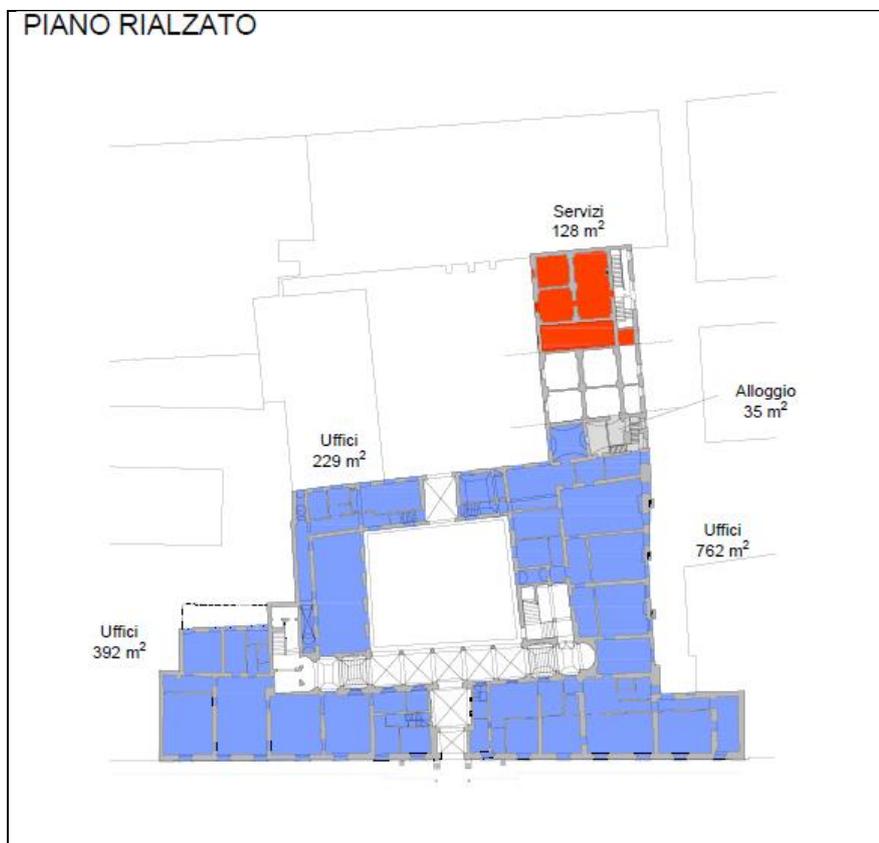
Piano di razionalizzazione – Riallocazione Amministrazioni (piano rialzato)
